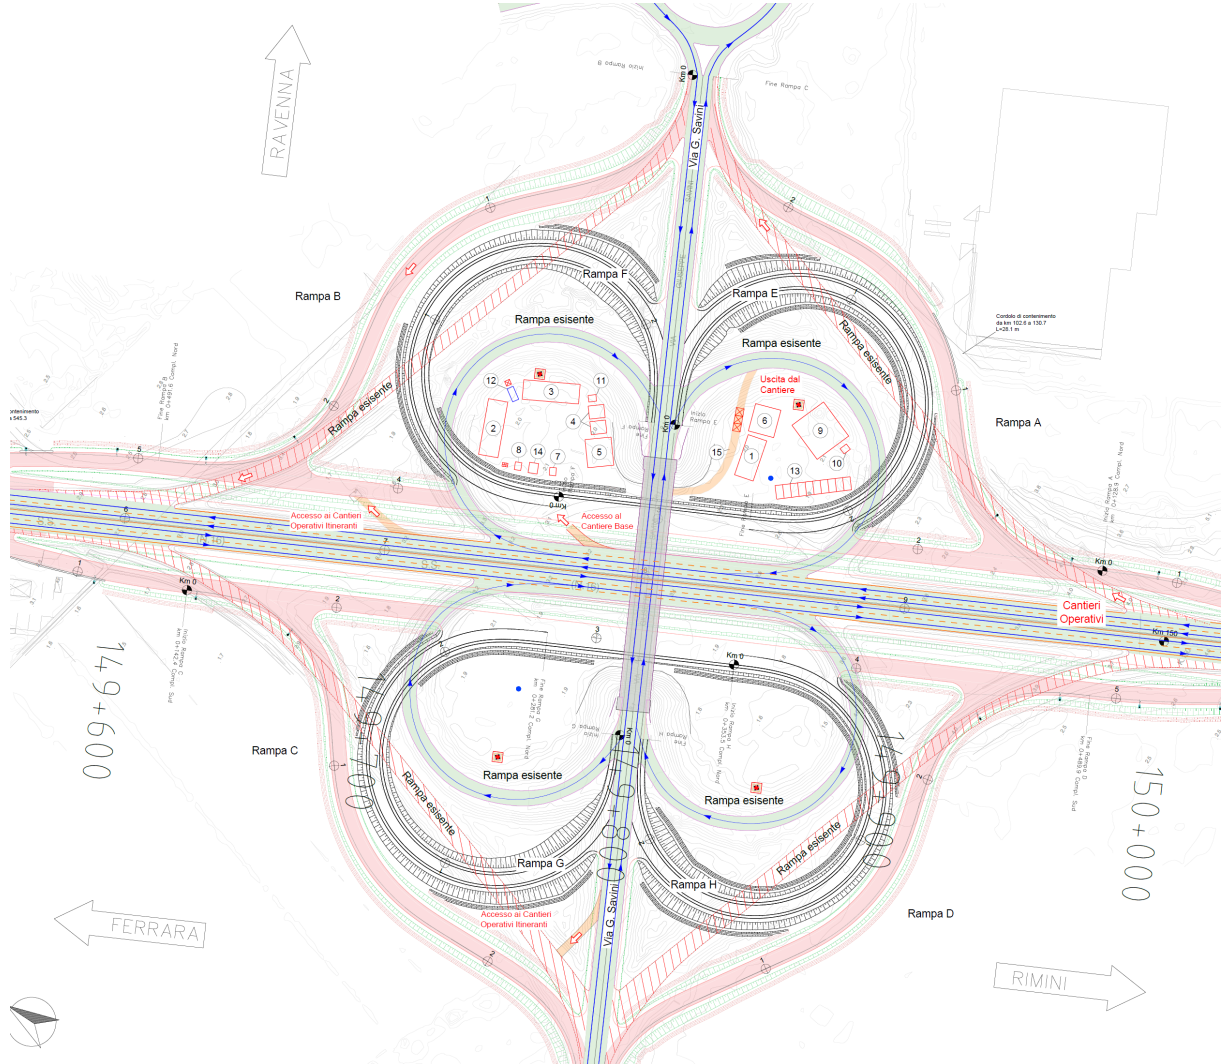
Aree di cantiere Base fisse – FASI 1 2 e 3
